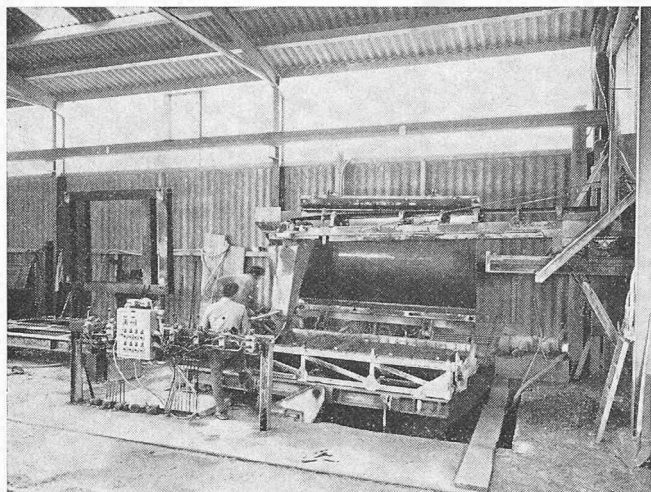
Schwenkbarer Rütteltisch mit den Stahlformen für die Tübbinge
